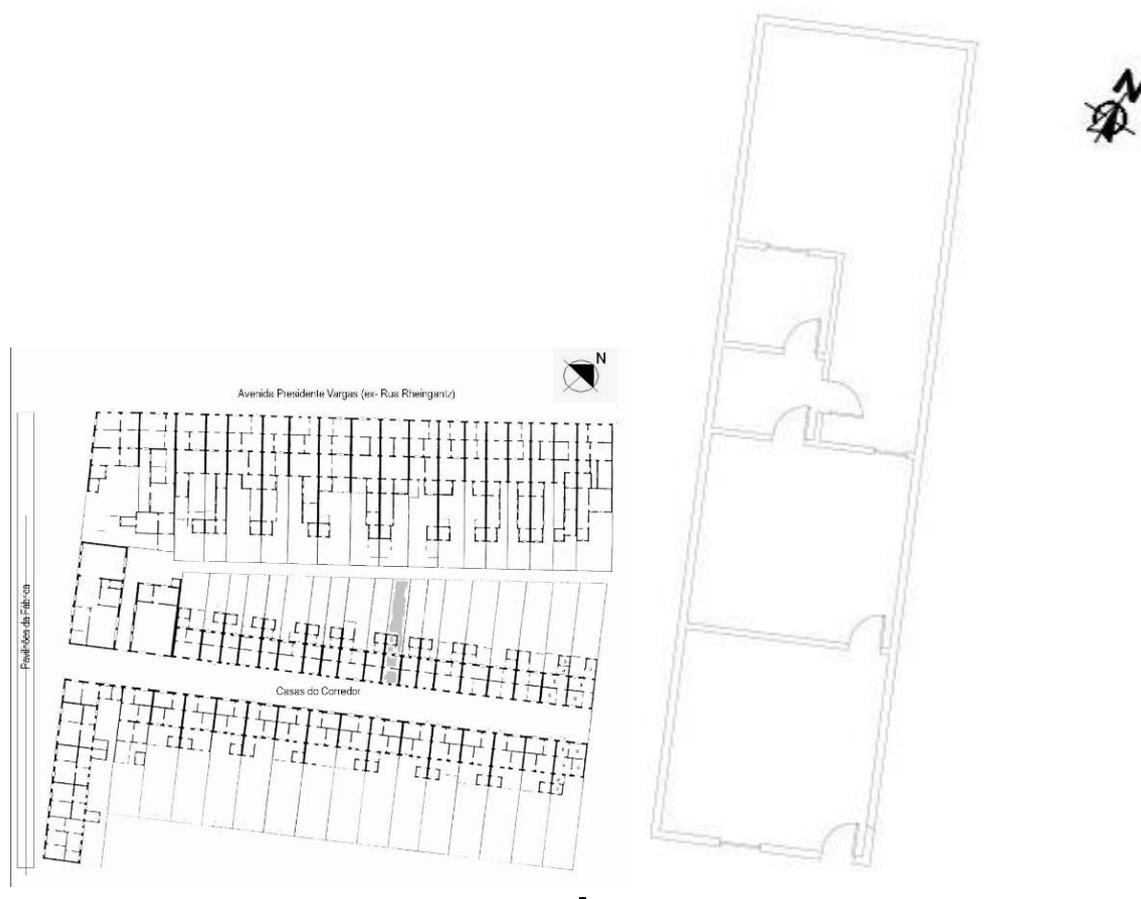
Planta da casa de 1884. Fonte: Ampliação da planta de Vivian Paulitsch (2003).
